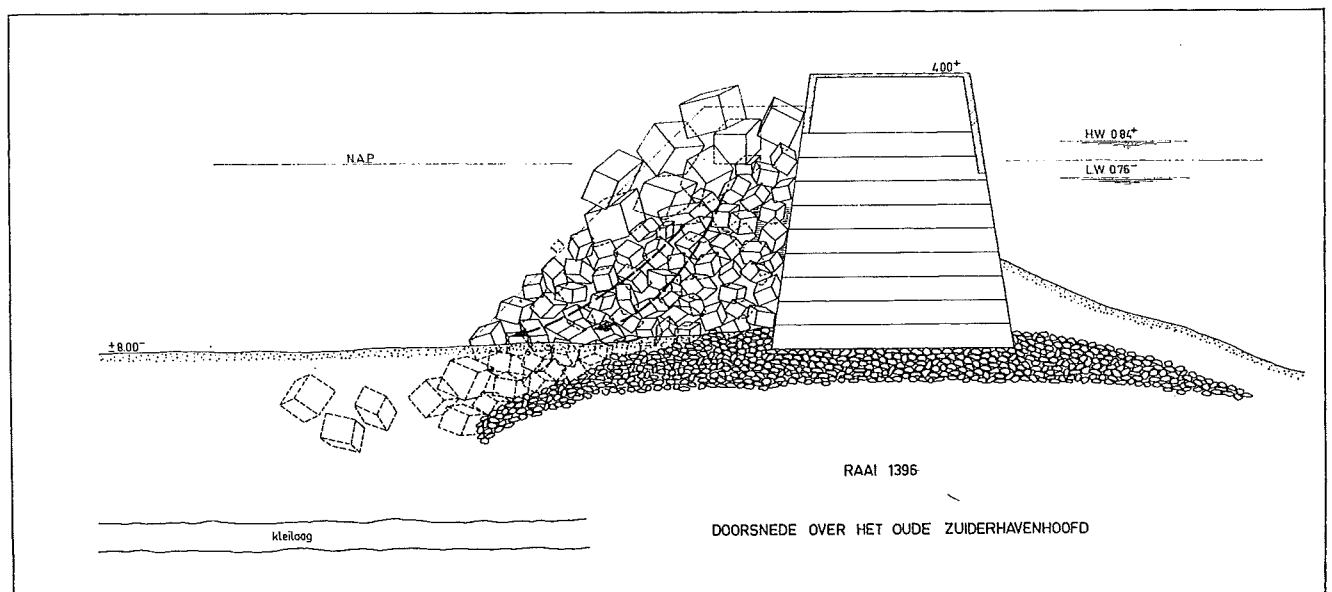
Doorsnede over havenhoofd, samengesteld uit blokken beton. Na het aanbrengen van een verbrede onderlaag werd deze aan de bovenzijde vlak bewerkt. Het buitenste „alleen”liggende blok zal spoedig zijn weggezakt.
